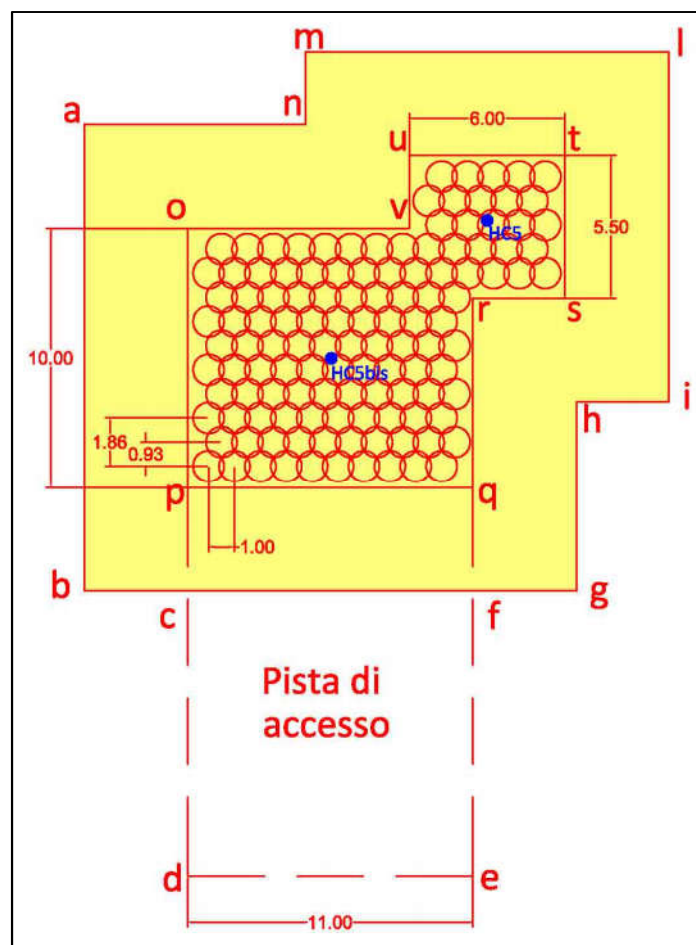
Individuazione planimetrica degli scavi di bonifica dell'areale H-d
